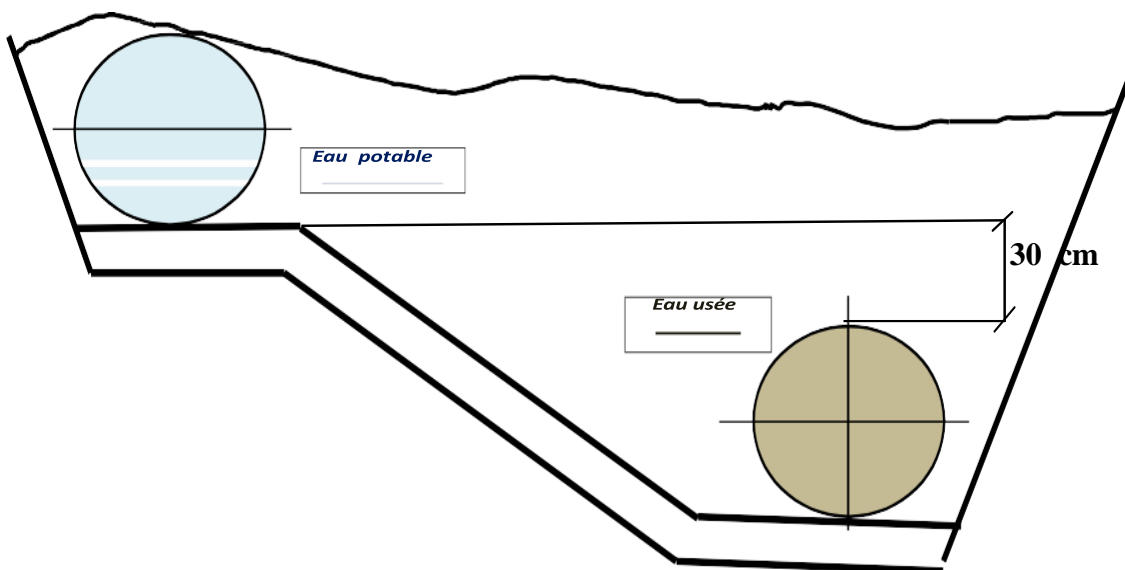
Pose à proximité d'une conduite d'assainissement.
